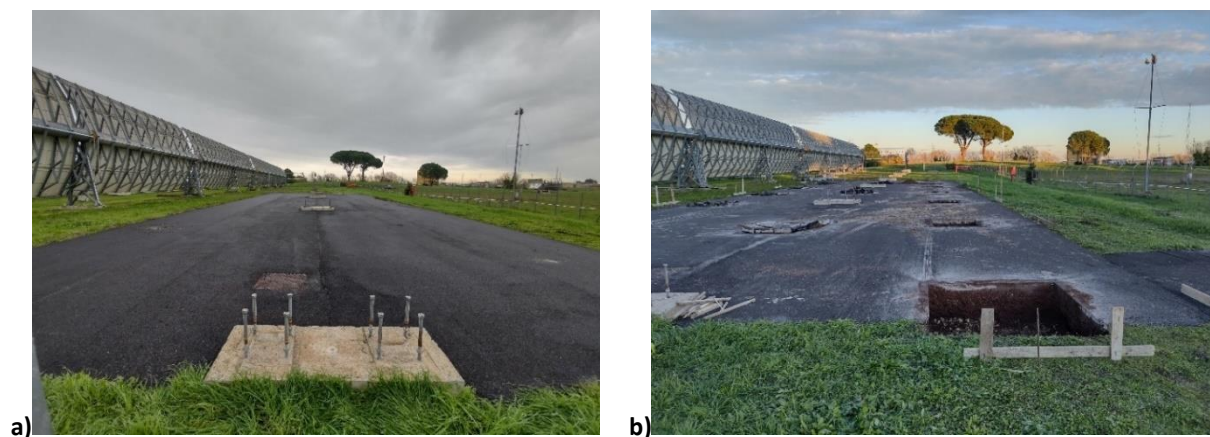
Area del collettore solare: a) prima delle opere di installazione; b) realizzazione degli scavi di fondazione.
